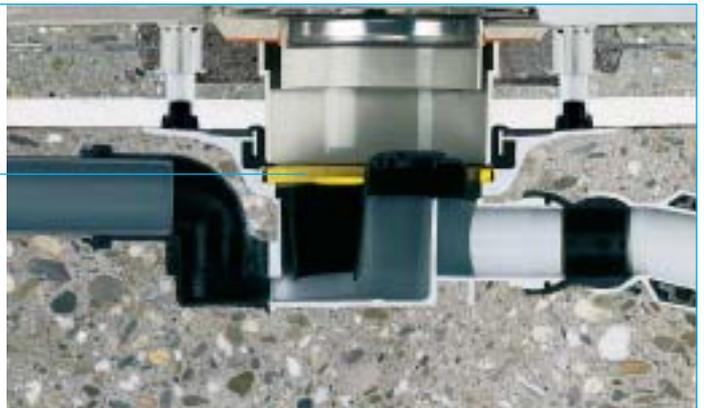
Der gelbe Distanzring zur Montage der Aufsatzstücke.
